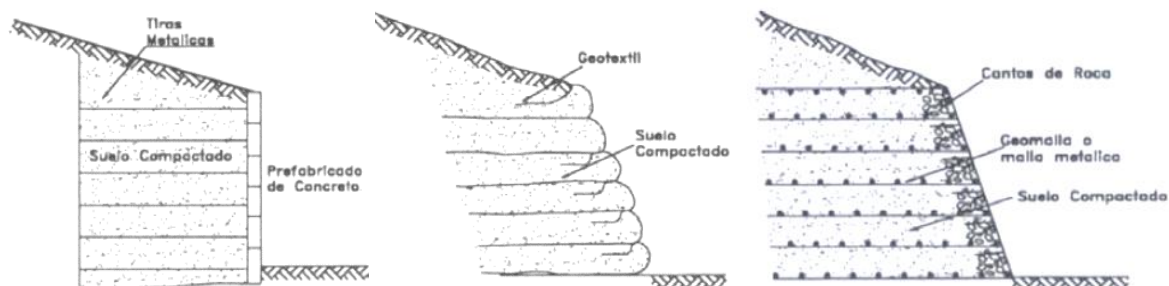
Tipos de estructuras de retención de suelo reforzado. Fuente: ACG (2009)
